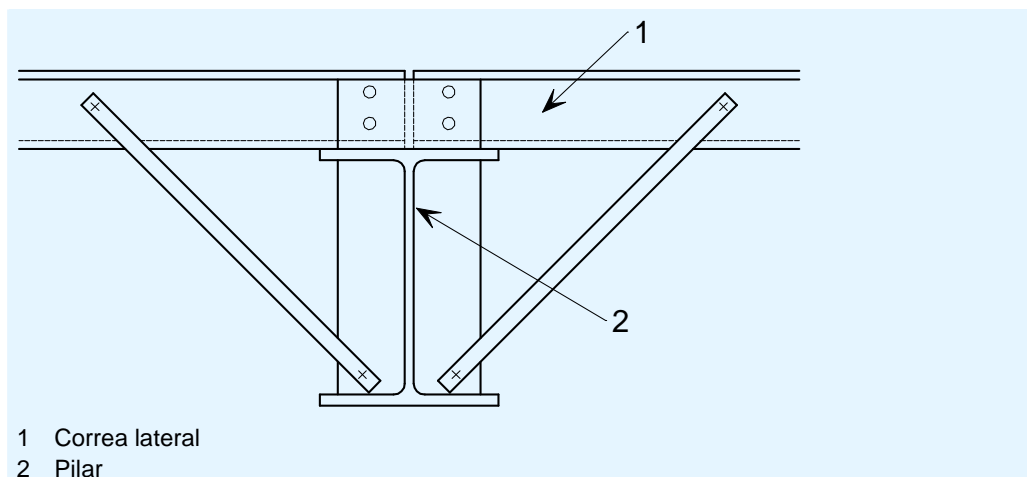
Detalle típico del alero donde con el pilar estabilizado
